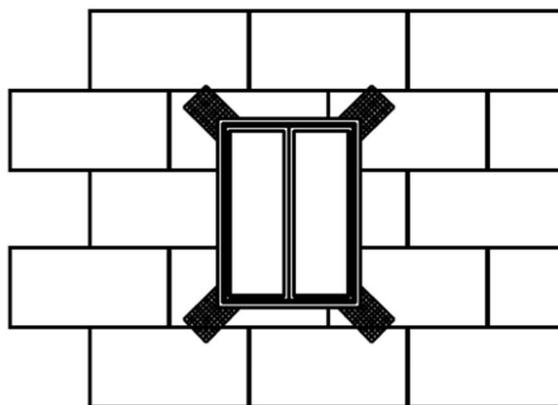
Dettaglio in corrispondenza degli spigoli delle finestre (da: Manuale di posa Waler 2016)
